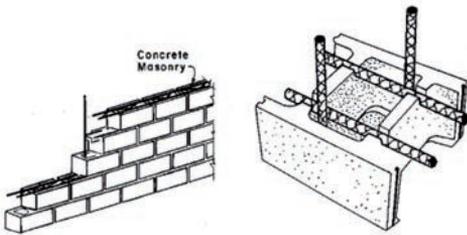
Detalle de muro ejecutado mediante bloque de hormigón y refuerzo de armado, resistente a solicitaciones y esfuerzos derivados de explosión.
